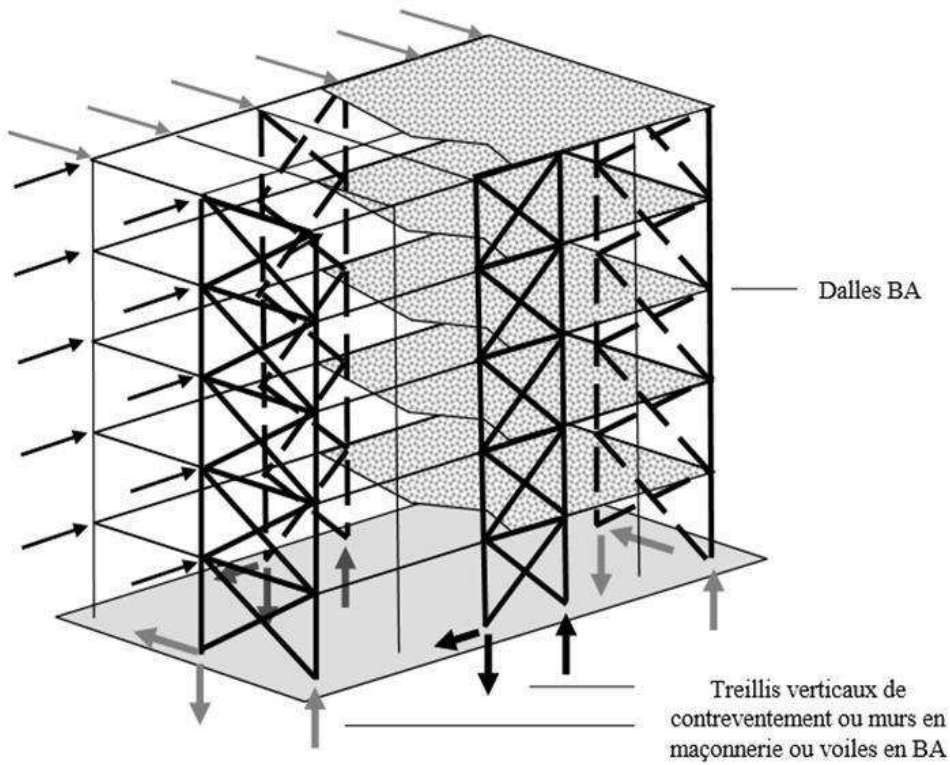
Stabilisation longitudinale et latérale d'un bâtiment à étages assurée par divers contreventements
